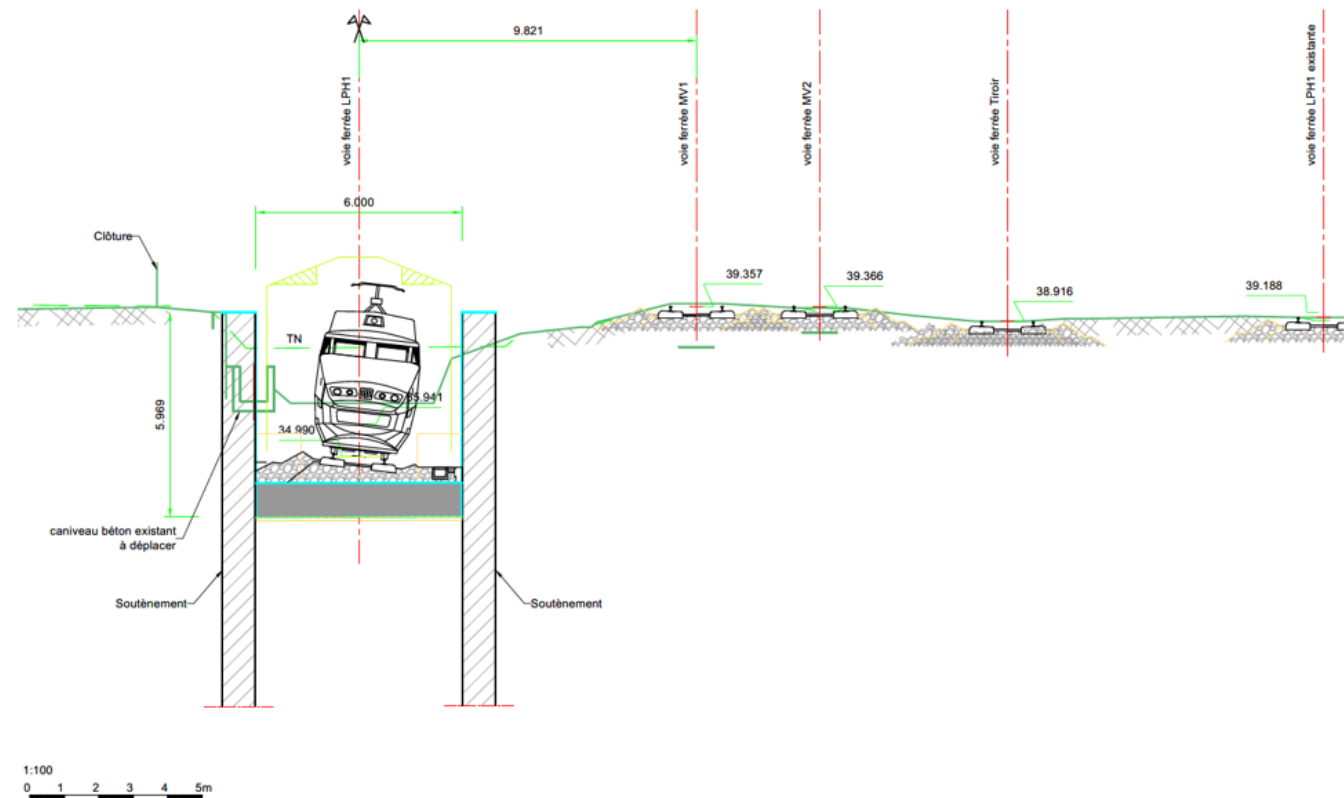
Vue en coupe de la rampe d'accès ouest du (Egis, 2021)
